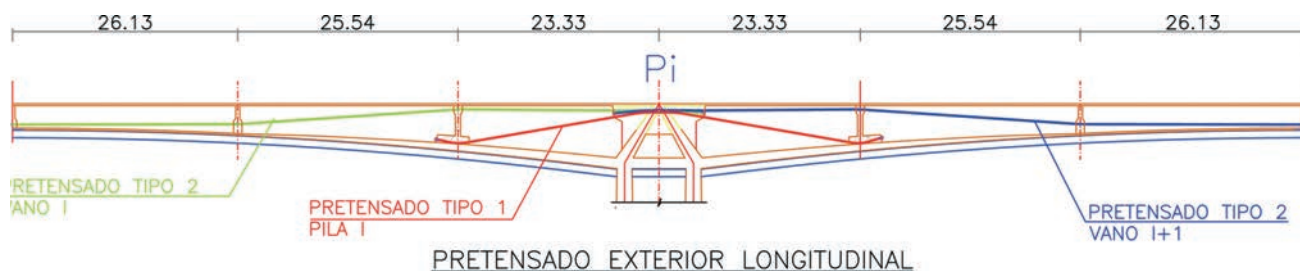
Pretensado exterior longitudinal. Alzado, familias tipo 1 y 2.
